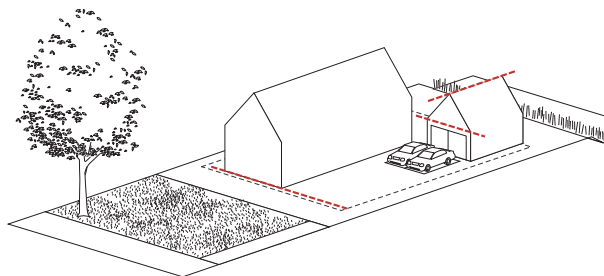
t/m 4.12: bouwregels hoofdgebouwen en bijgebouwen:
